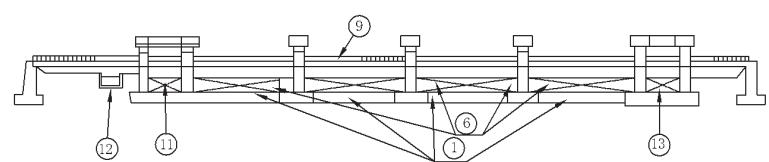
引上げ式ゲートを有する可動堰の各部の名称
